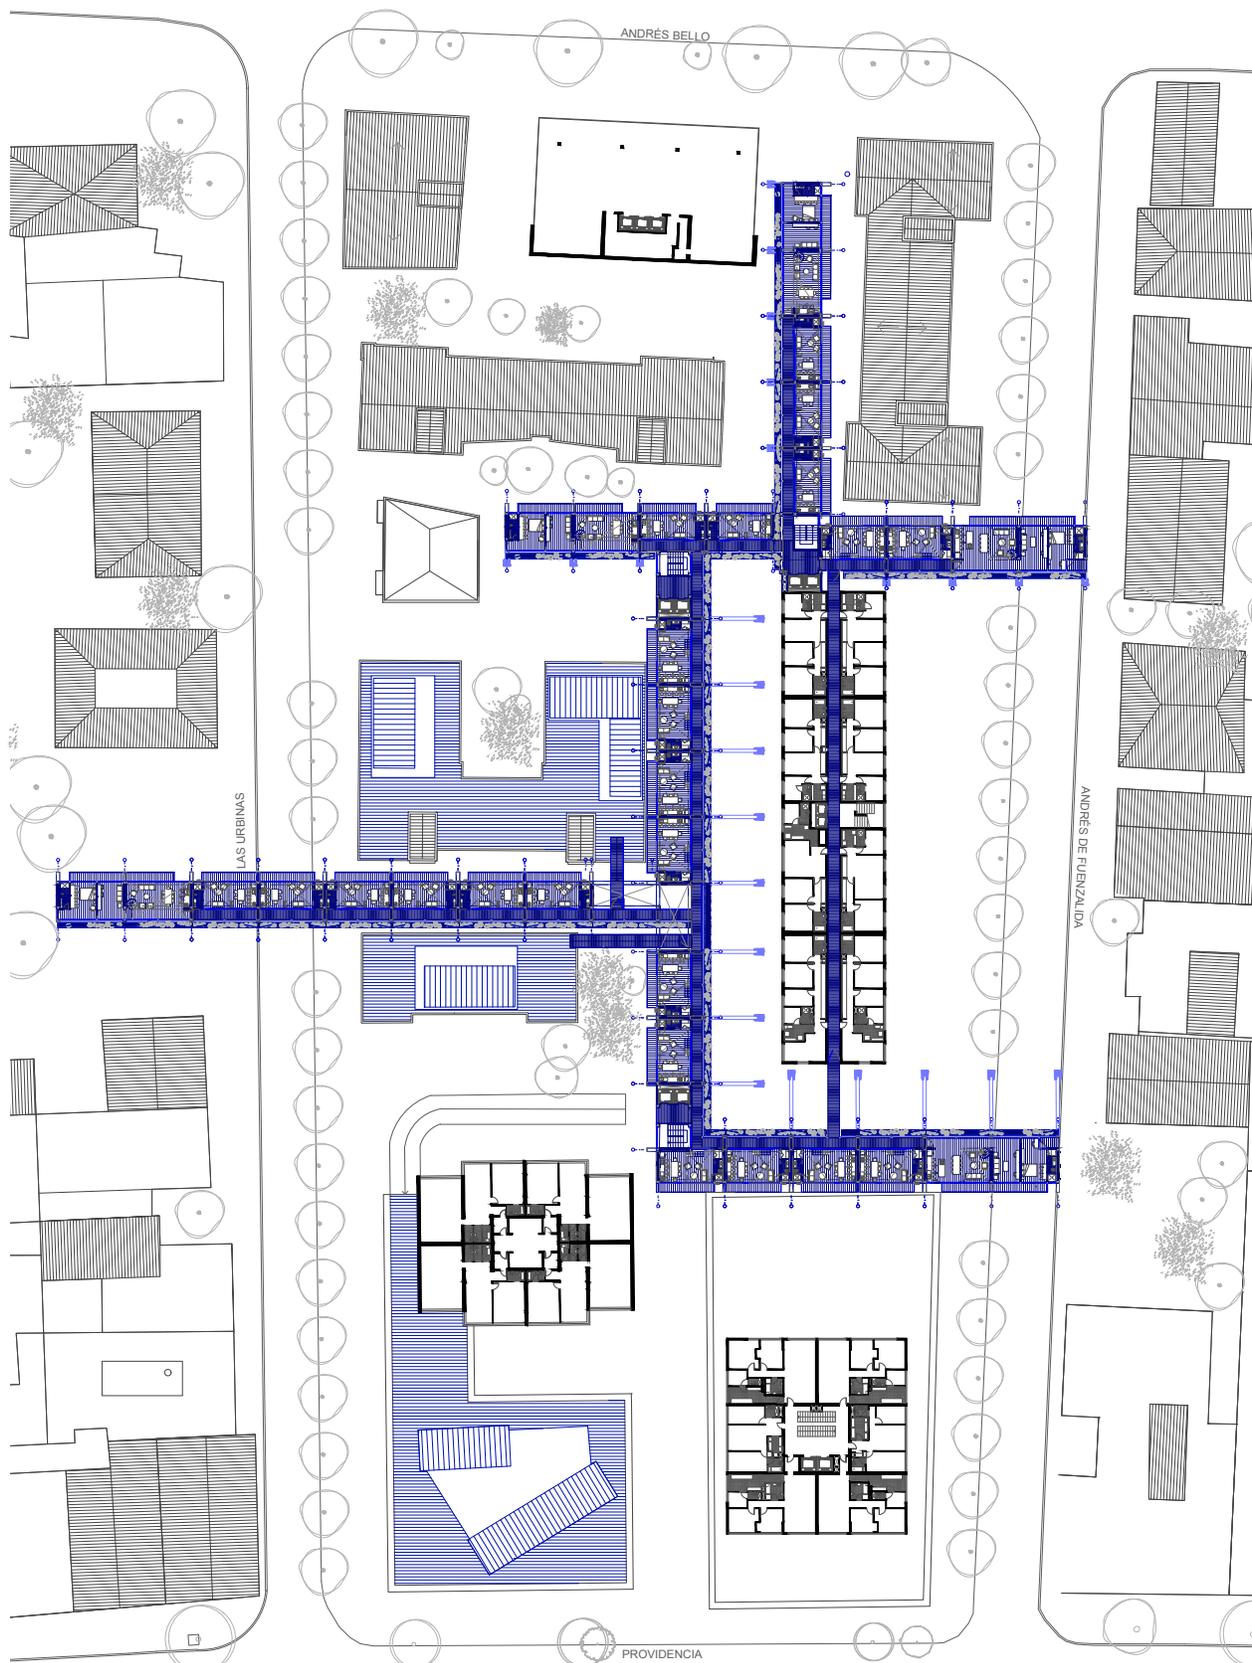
Planta nivel 5 (1er piso edificio). Fuente: Elaboración Propia.
